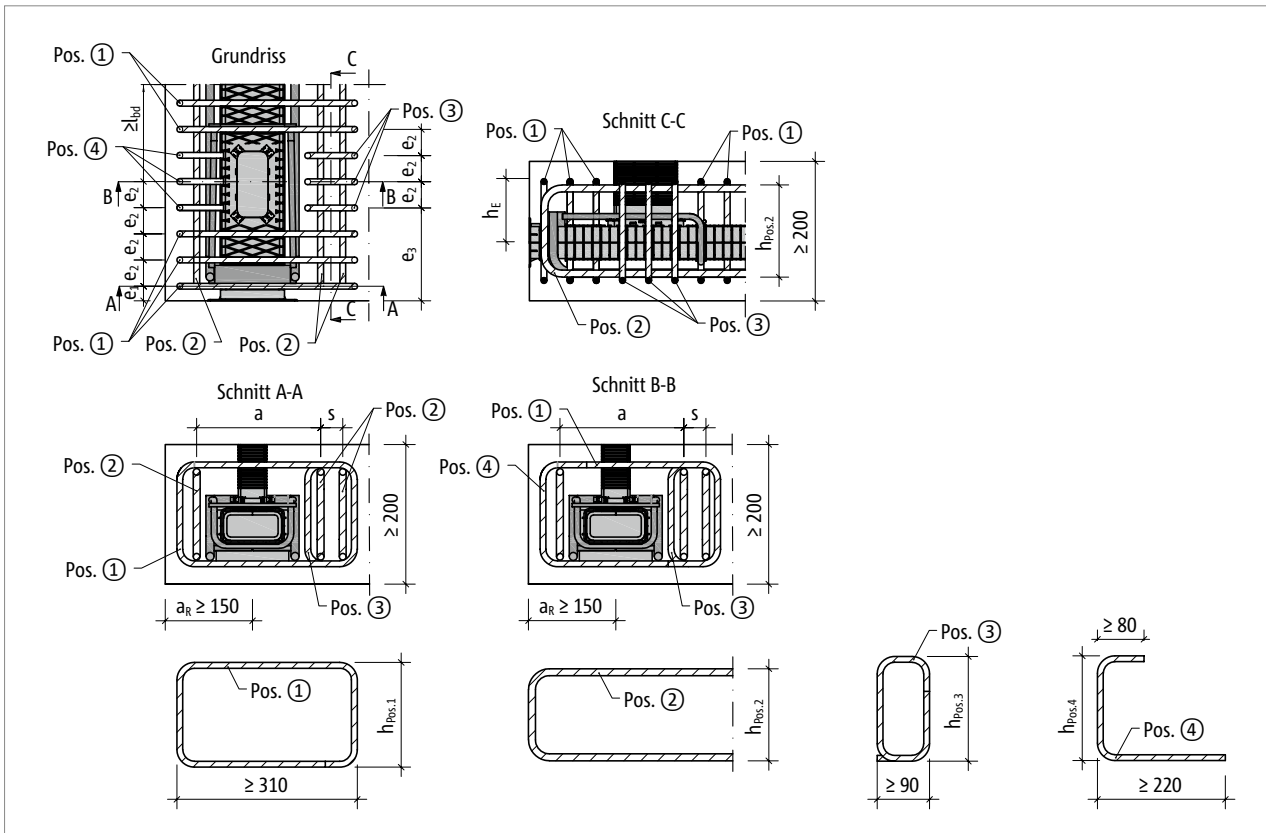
Tronsole® M: Bauseitige Bewehrung für höhere Tragfähigkeiten
